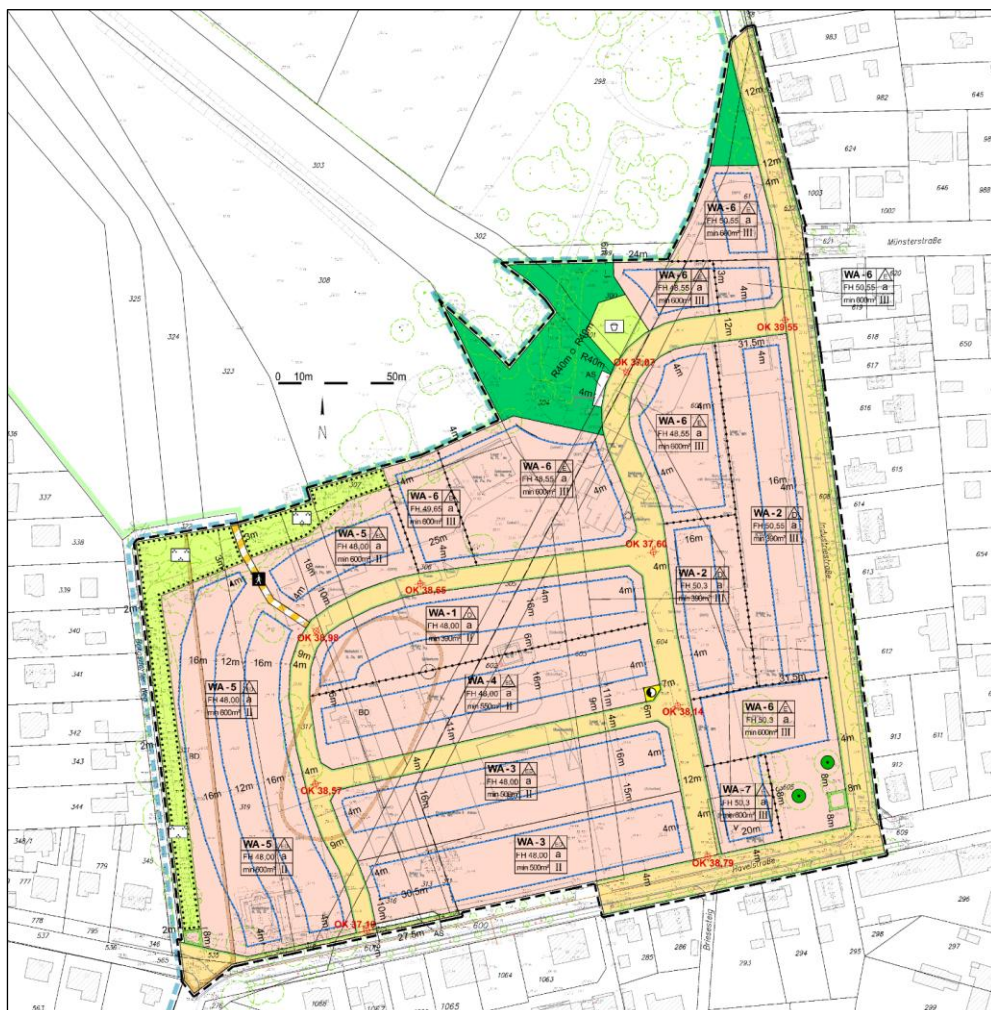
Bebauungsplan Nr. 37-2 „Wohngebiet Havelstraße – Industriestraße“<sup>16</sup>
